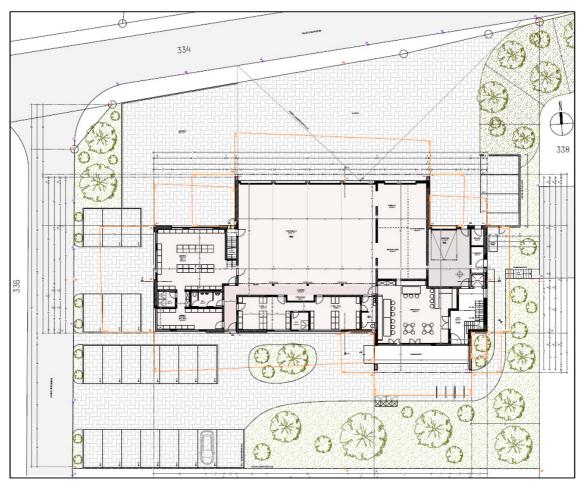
Grundriss des geplanten Gemeinschaftshauses /18/
